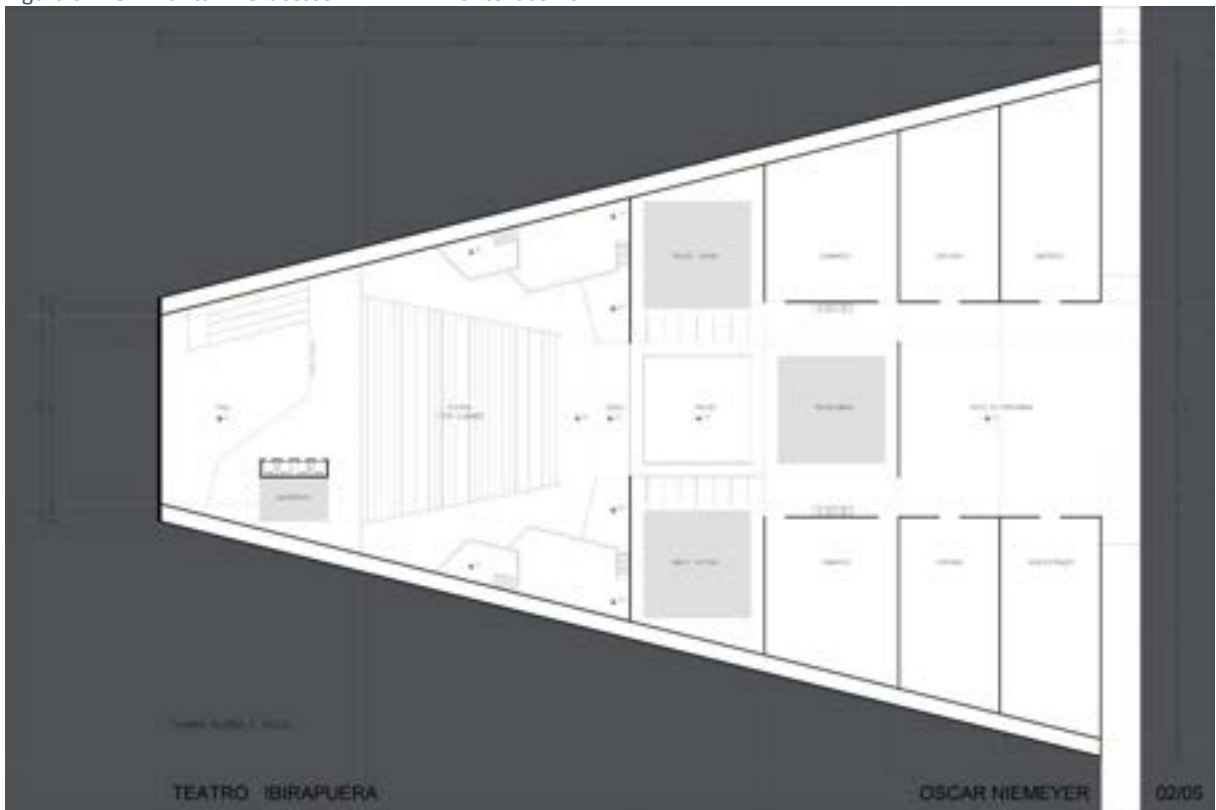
Planta nível inferior – MMBB – Fonte: acervo MMBB
